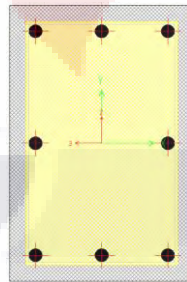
Detalle del modelado de la sección trabe dentro del software SAP2000.
